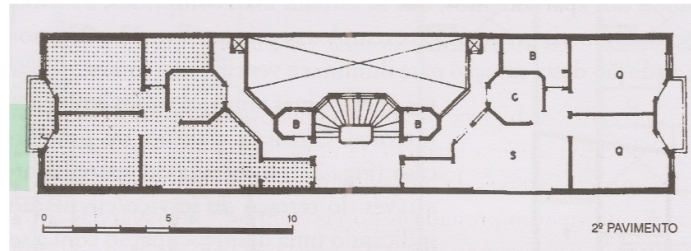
B – Planta baixa “casa de apartamentos”, Rua Bento
